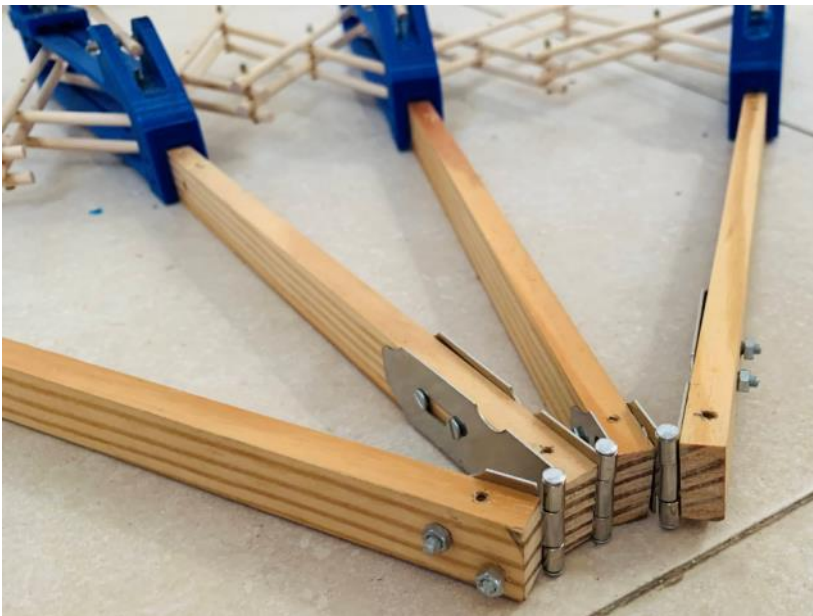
Maqueta de medio domo desplegable. Detalle bisagras entre vigas
